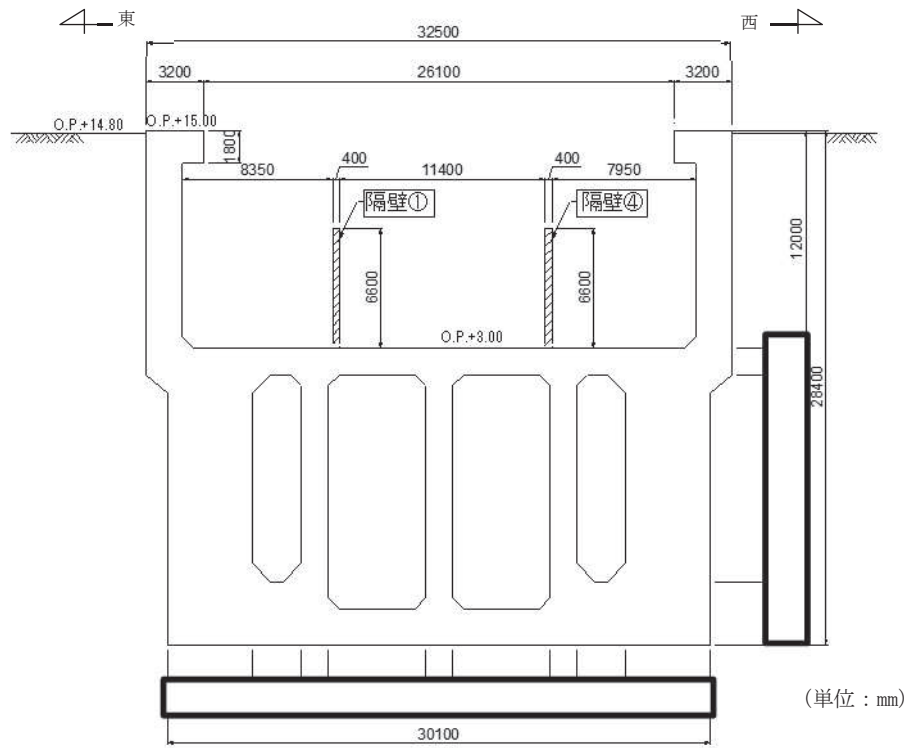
(1) 補機ポンプエリア断面図 (①—①断面)
